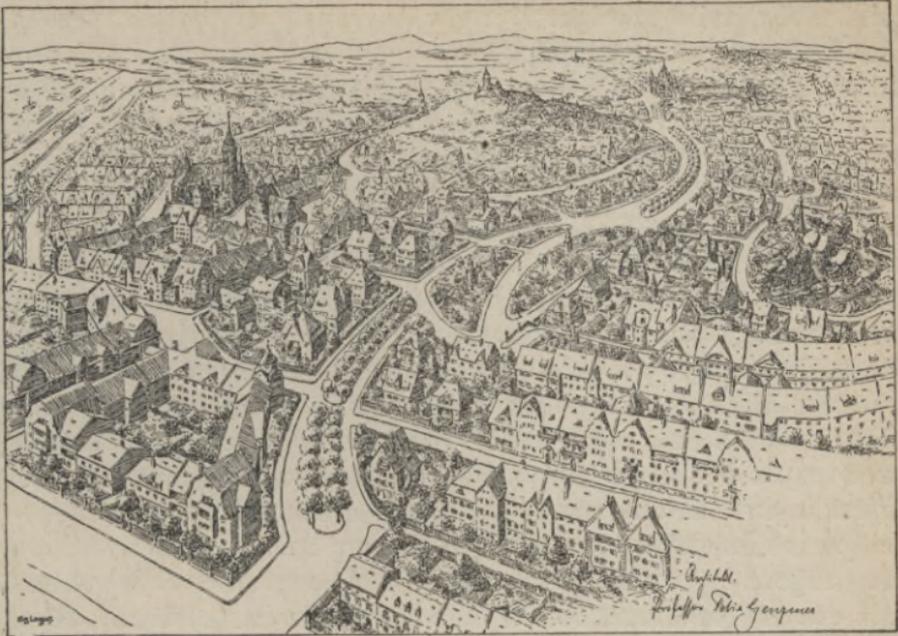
Bebauungsplan für das Fischerberg-Gelände der Stadt Hirschberg i. Schl., Schaubild und Lageplan.
